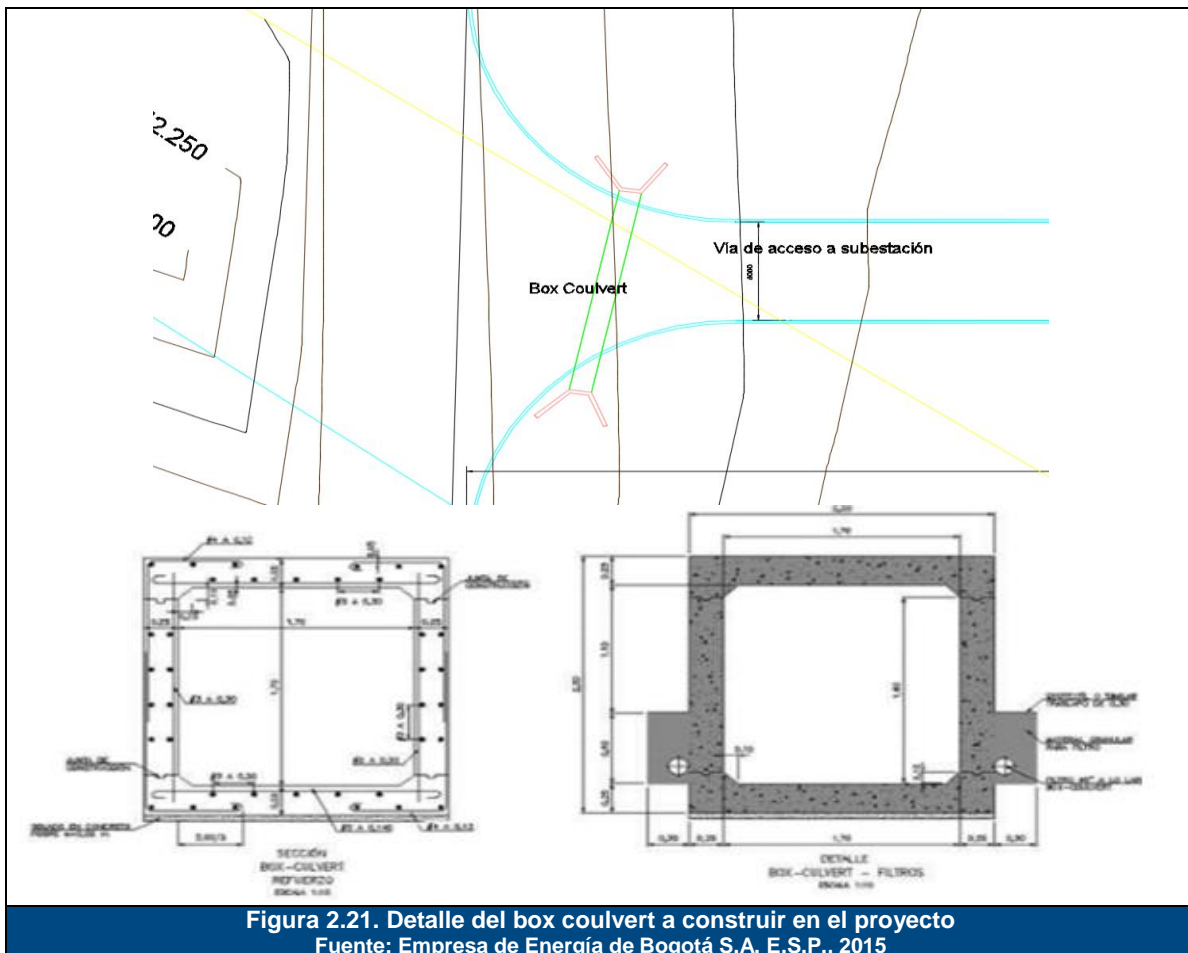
Detalle del box coulvert a construir en el proyecto
